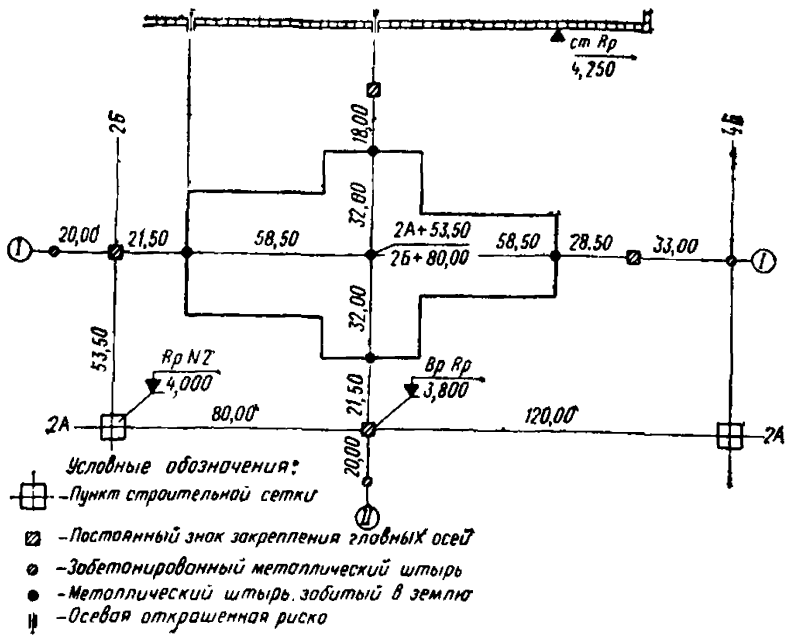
Исполнительная схема разбивки и закрепления главных осей
